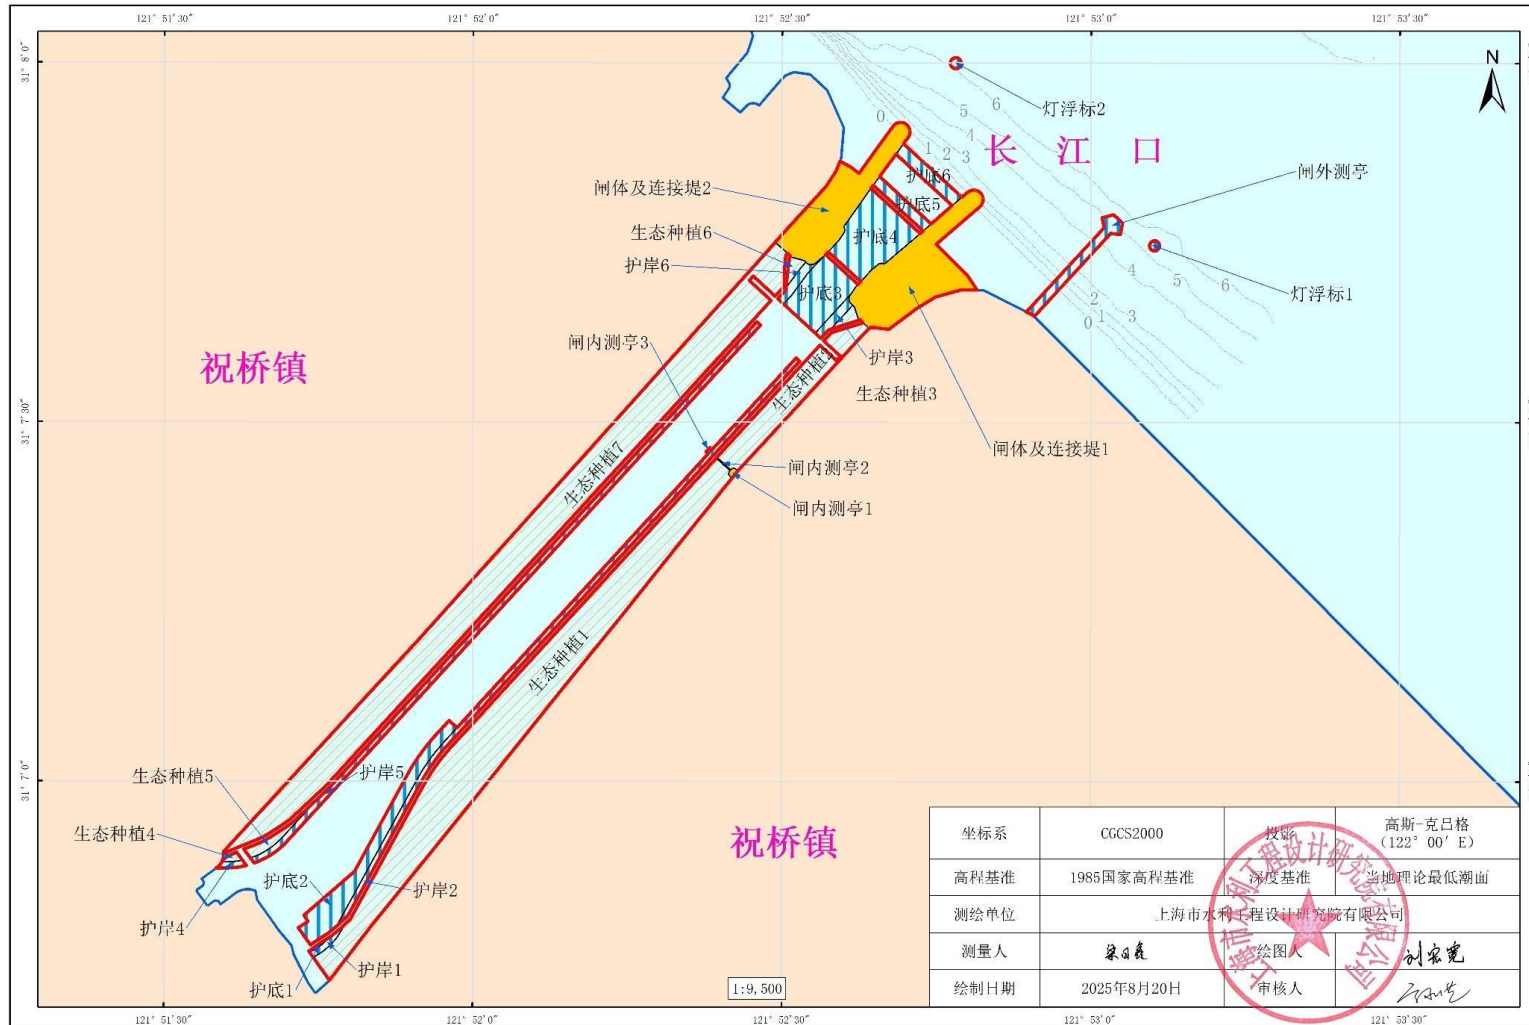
已批复宗海平面布置图（主体工程施工阶段）
